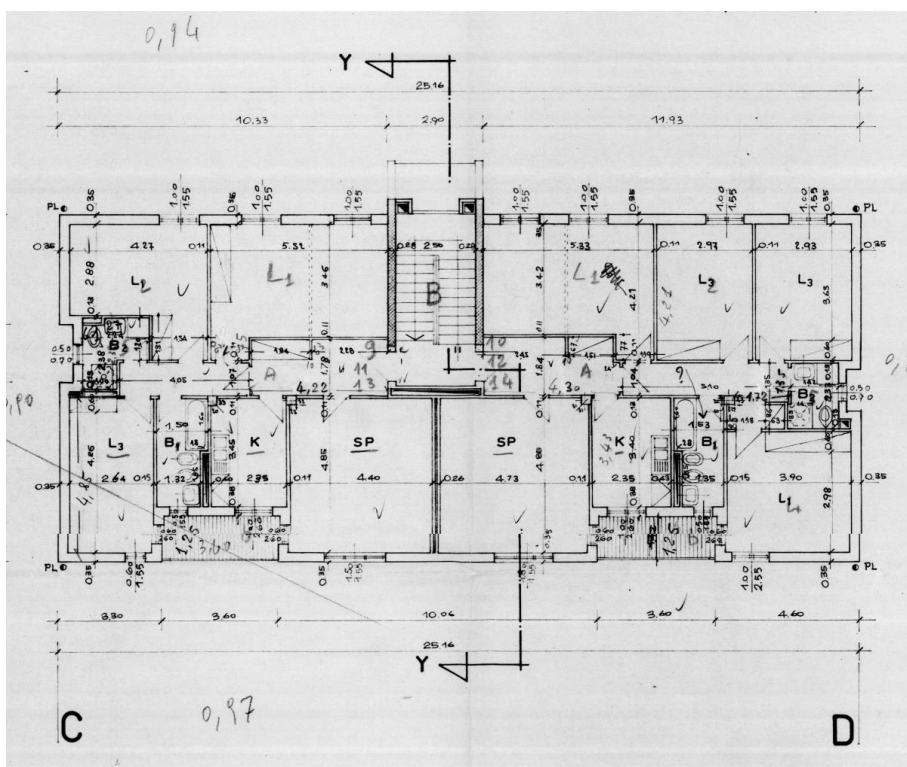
, Pianta Piano Tipo, scansione progetto originale
